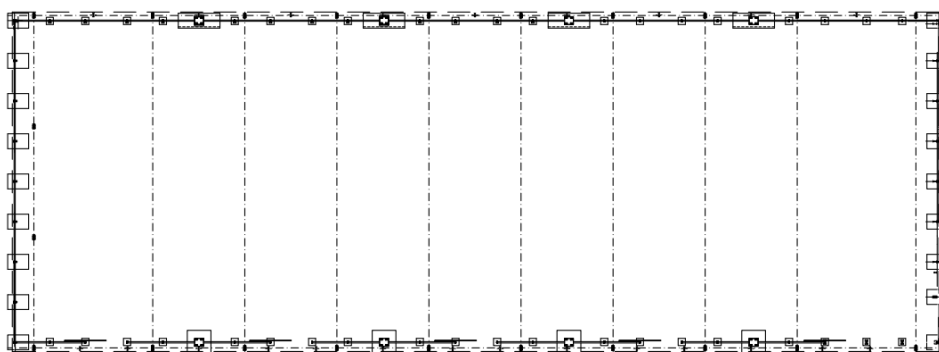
Armazém Portuário - Disposição Nova – Apresentação Projetista
